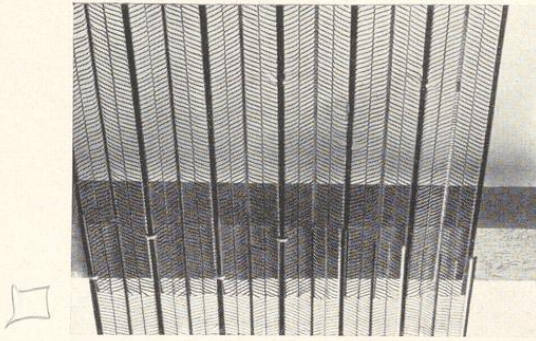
und 827. Befestigung des Rippenstreckmetalls an Holzbalken mit Nägeln und Krampen
